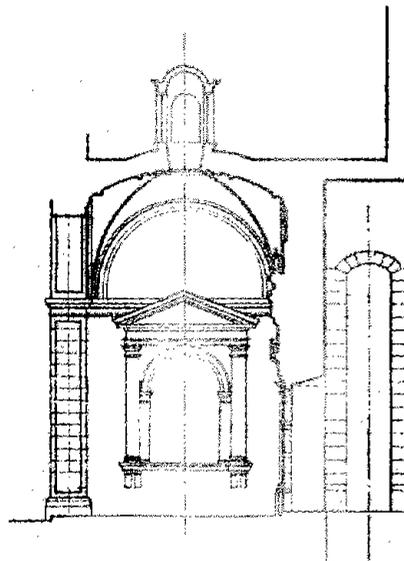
Alzado de encasamento de la Catedral de México.
